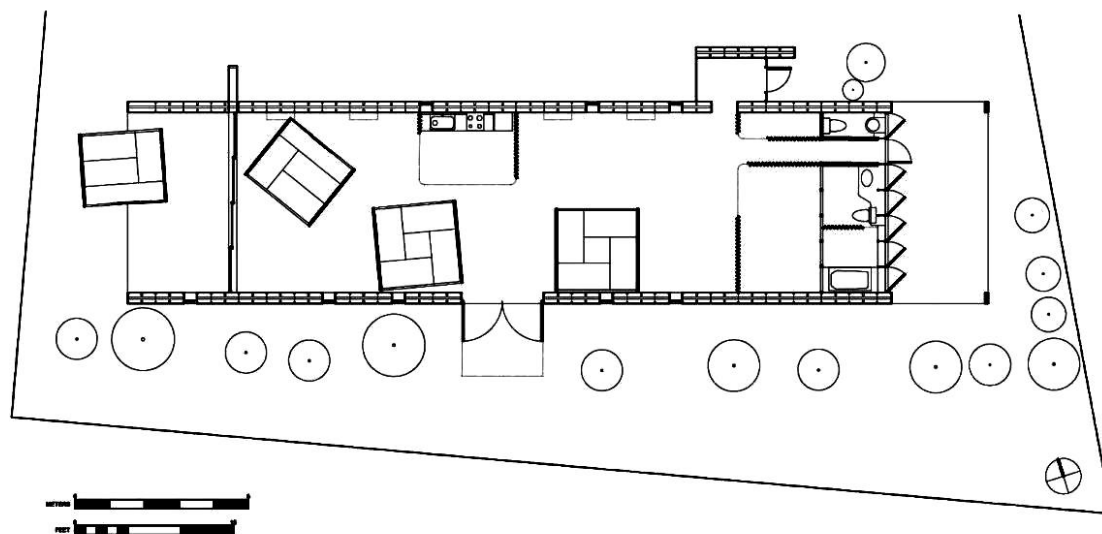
План этажа Обнаженного дома, арх. Шигеру Бан. Фото плана предоставлено: Shigeru Ban Architects [Источник: <https://archeyes.com/naked-house-shigeru-ban/>]
